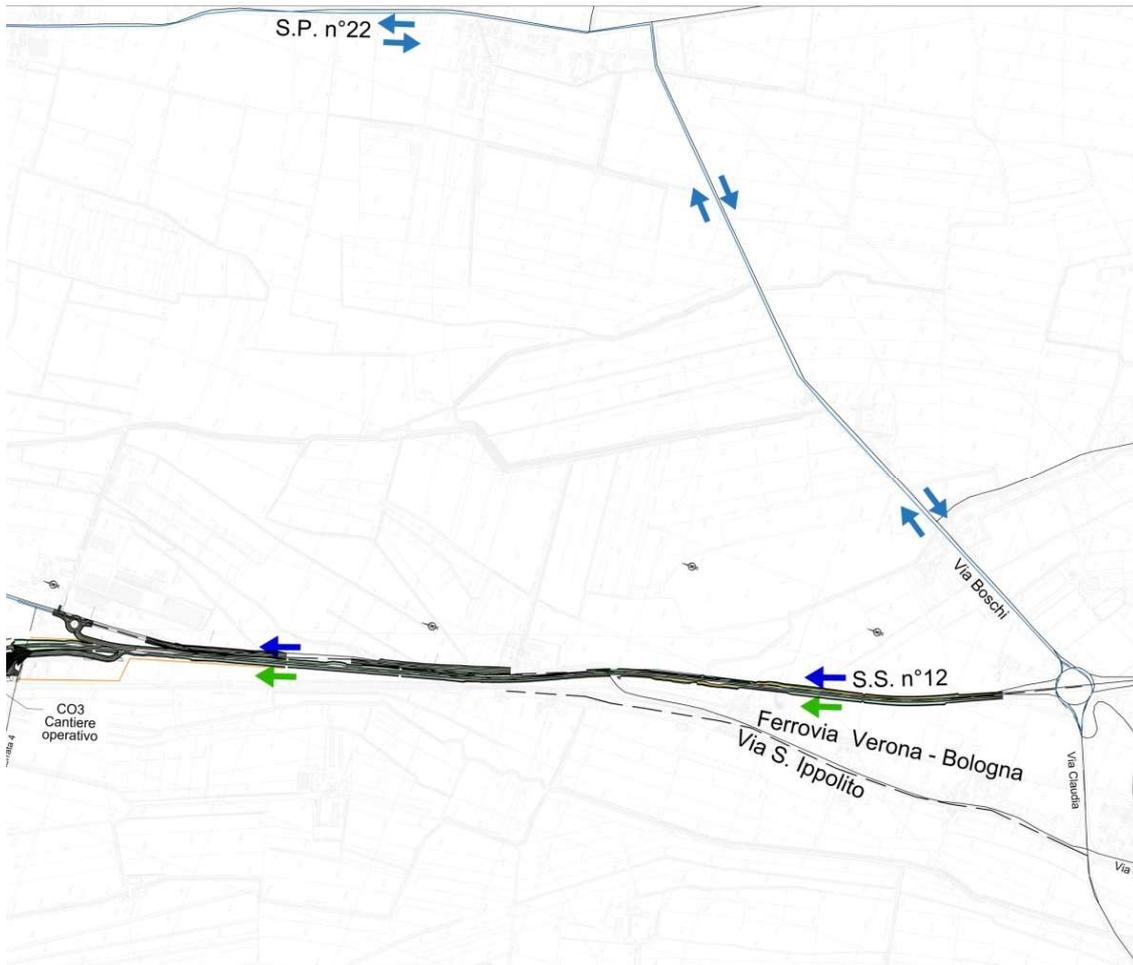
Stralcio 21-004_T00CA00CANPL02_A – Planimetria aree e vibiltà di cantiere
